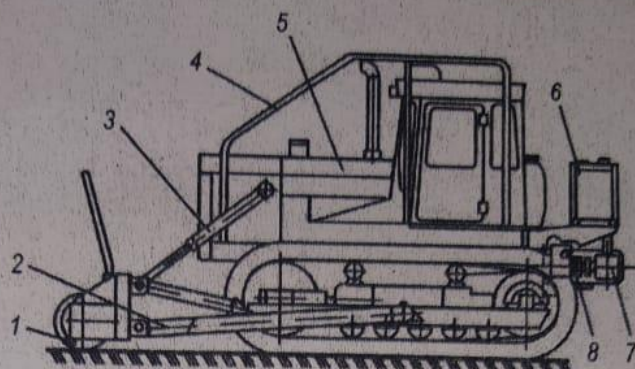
Кусторез с фрезерным рабочим органом: 1 — ротор-измельчитель в кожухе; 2 — толкающие брусья; 3 — гидроцилиндры подъема и опускания ротора; 4 — защитная конструкция; 5 — базовая машина; 6 — гидросистема; 7 — насос; 8 — ходоуменьшитель
